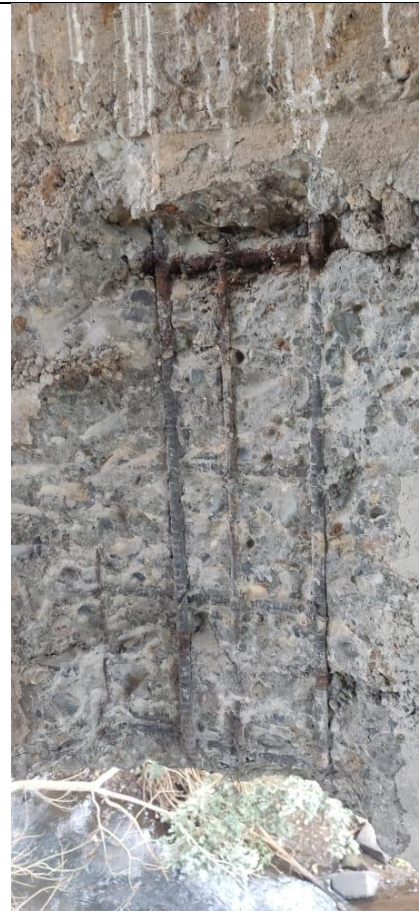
Acero de refuerzo transversal existente en viga cabezal.
